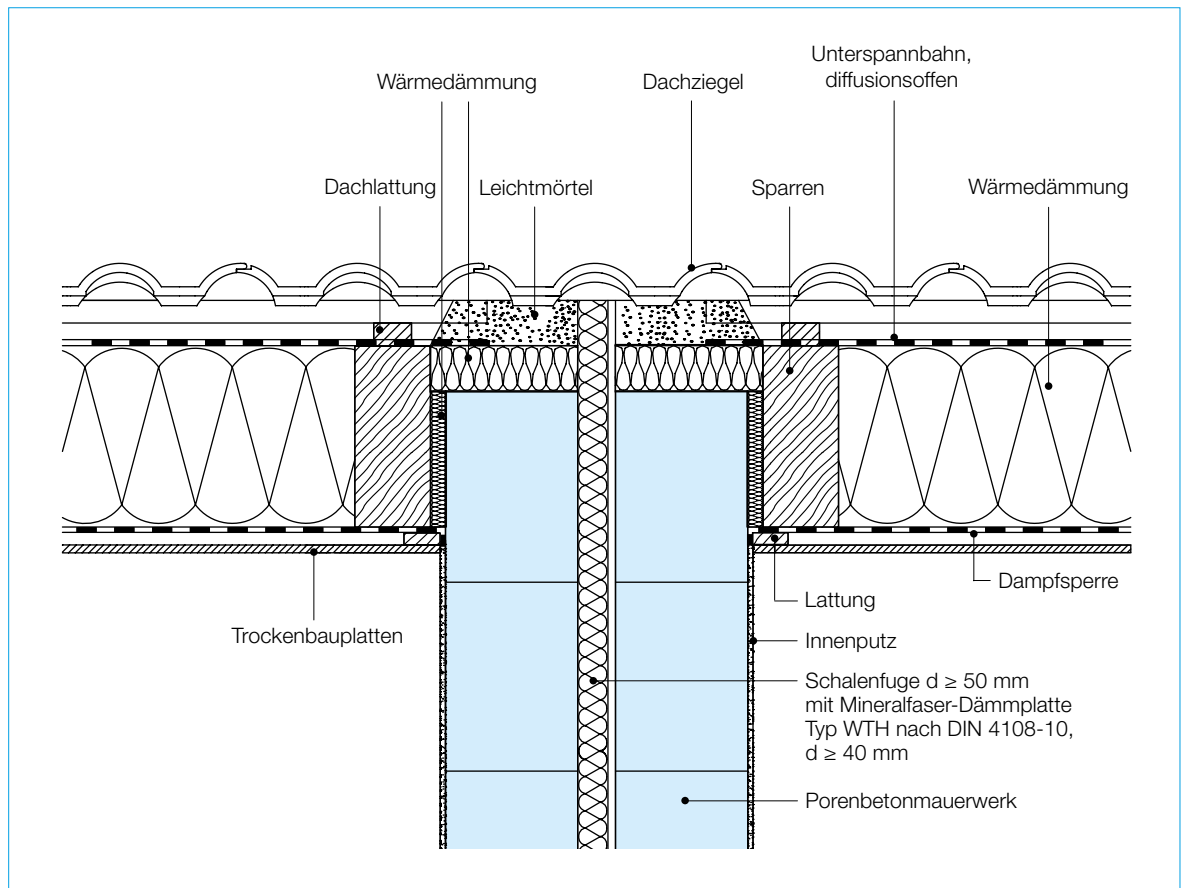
Dachanschluss einer zweischaligen Haustrennwand aus Porenbetonmauerwerk an ein Holzdach
